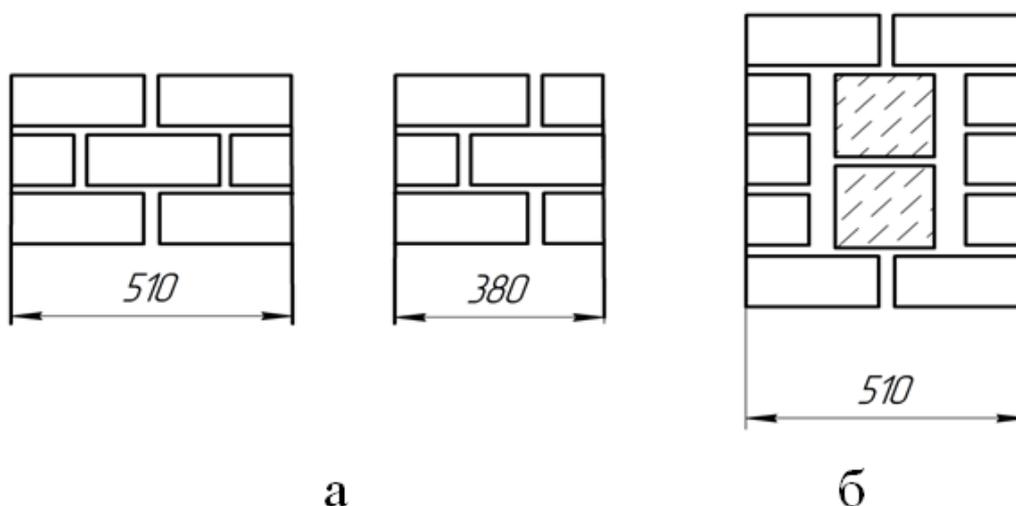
Схемы поперечных разрезов кирпичных стен: а – стены в два и полтора кирпича; б – облегченные стены в два кирпича
